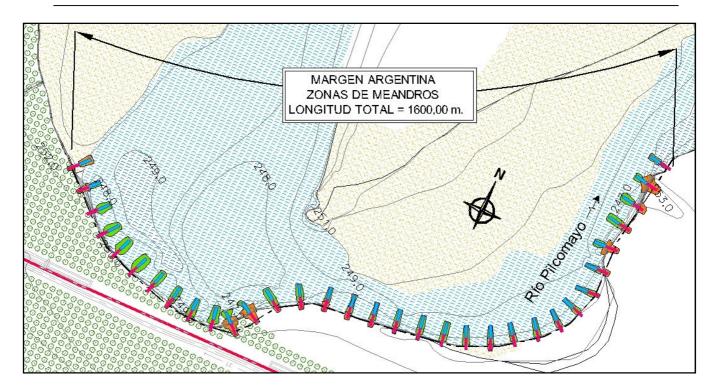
Planta de disposición de los espigones en la zona de meandros
